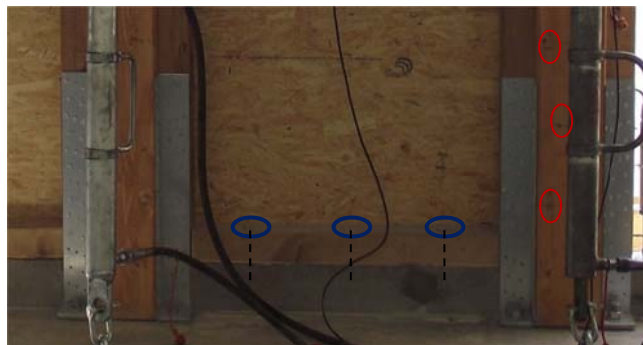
Elementi di connessione a terra e tra i moduli parete – lato interno
